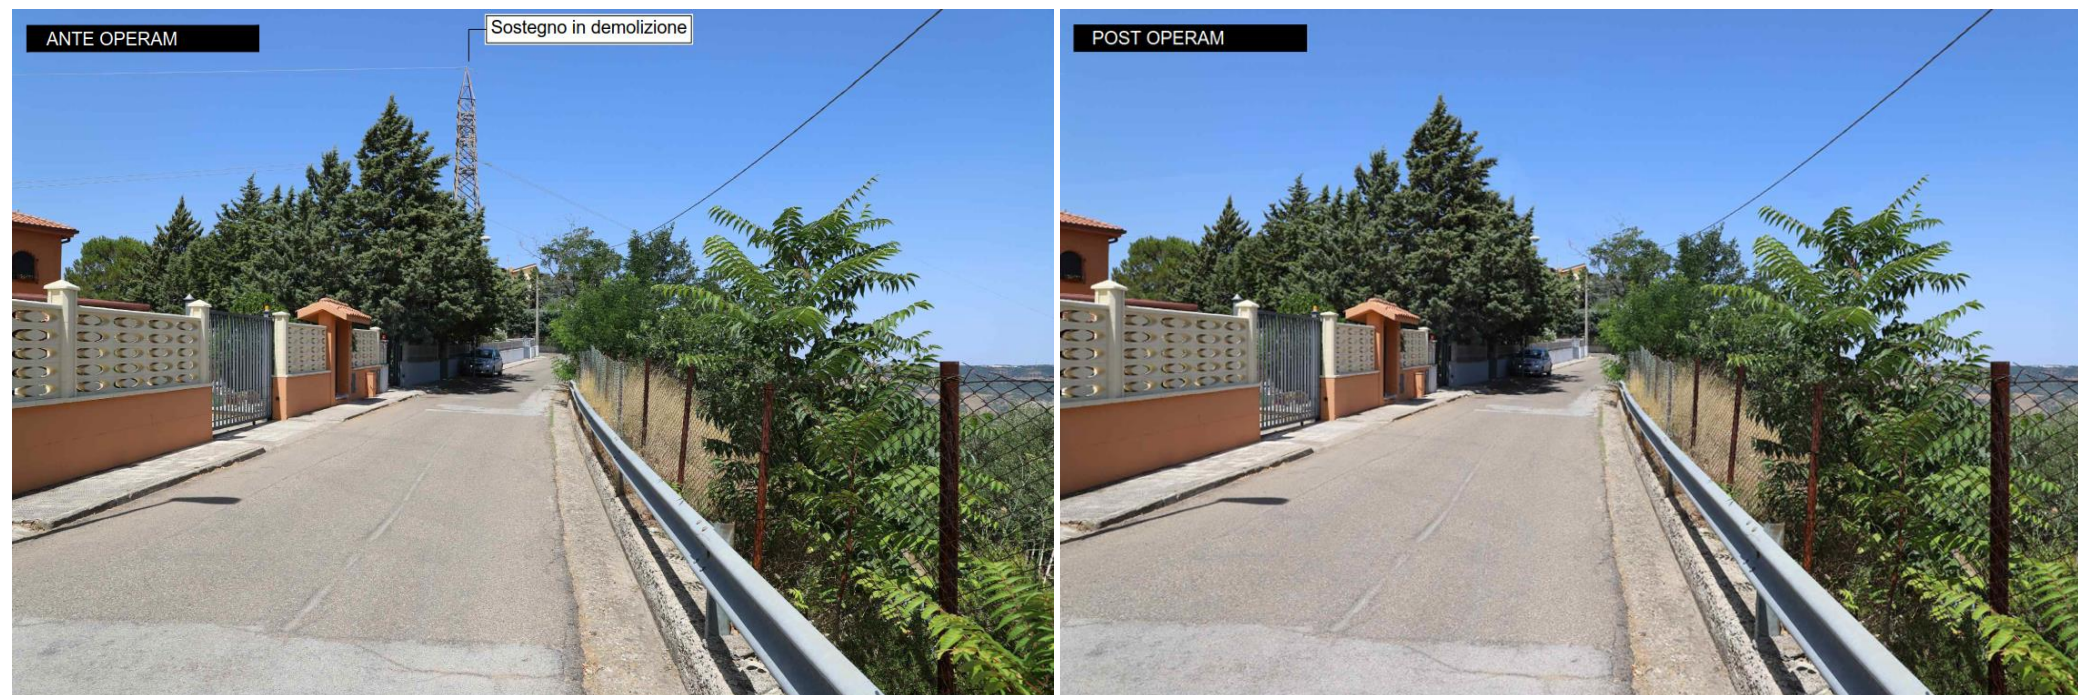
Fotografia dal PR.2a - situazione attuale (a sinistra) e situazione in previsione (a destra)
